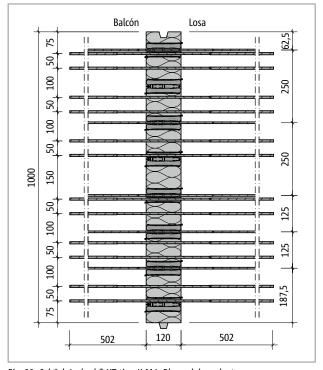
Schöck Isokorb® XT tipo K-M4: Plano del producto
